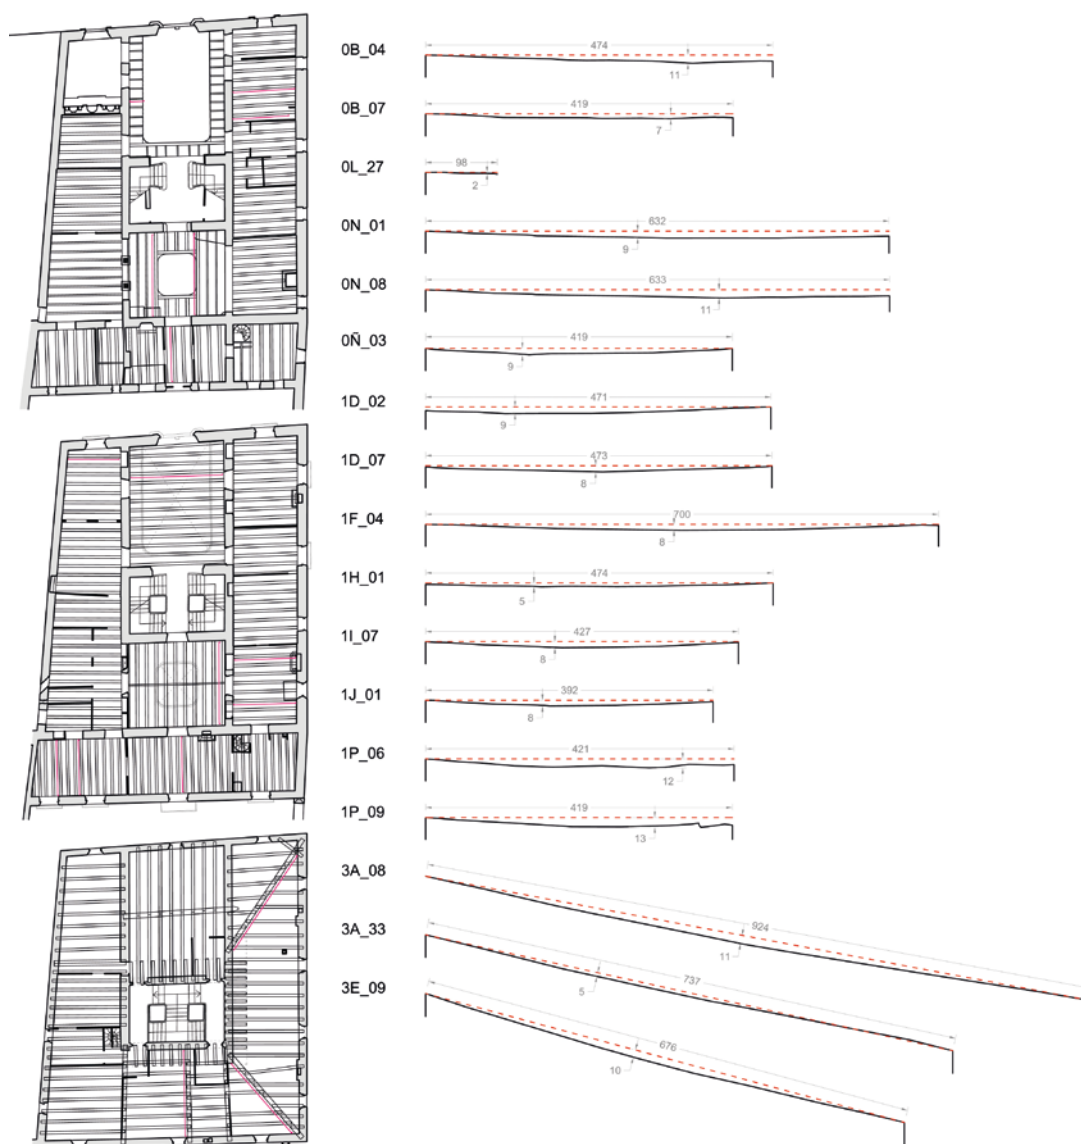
Vigas en las que puntualmente se ha medido la deformación.
